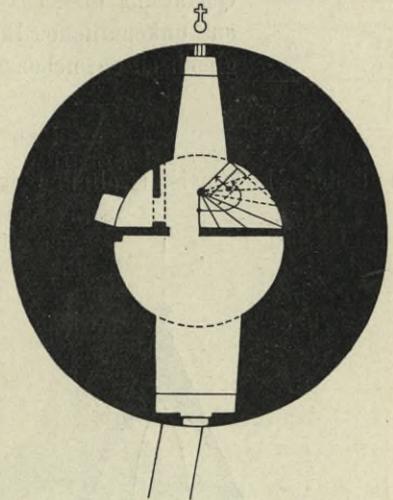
Wendischer Turm, Grundriß eines Obergeschosses.
